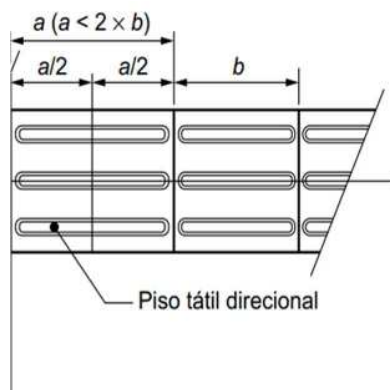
Piso tátil a ser instalado no interior da edificação
